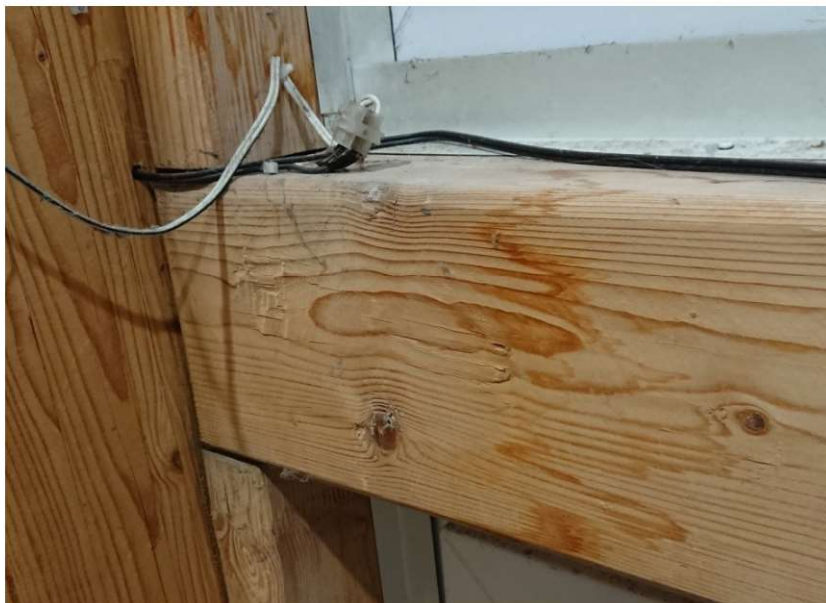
Wskutek kolizji wywiewki kanalizacji z elementem konstrukcji, zakończono rurę pod elementem drewnianym, czego efektem jest widoczna na zdjęciu korozja biologiczna elementu drewnianego (fot. U. Kotwica)
